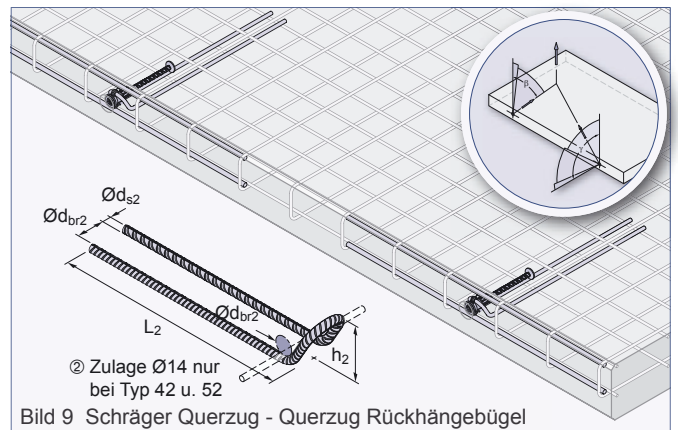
Schräger Querkzug - Querkzug Rückhängebügel
